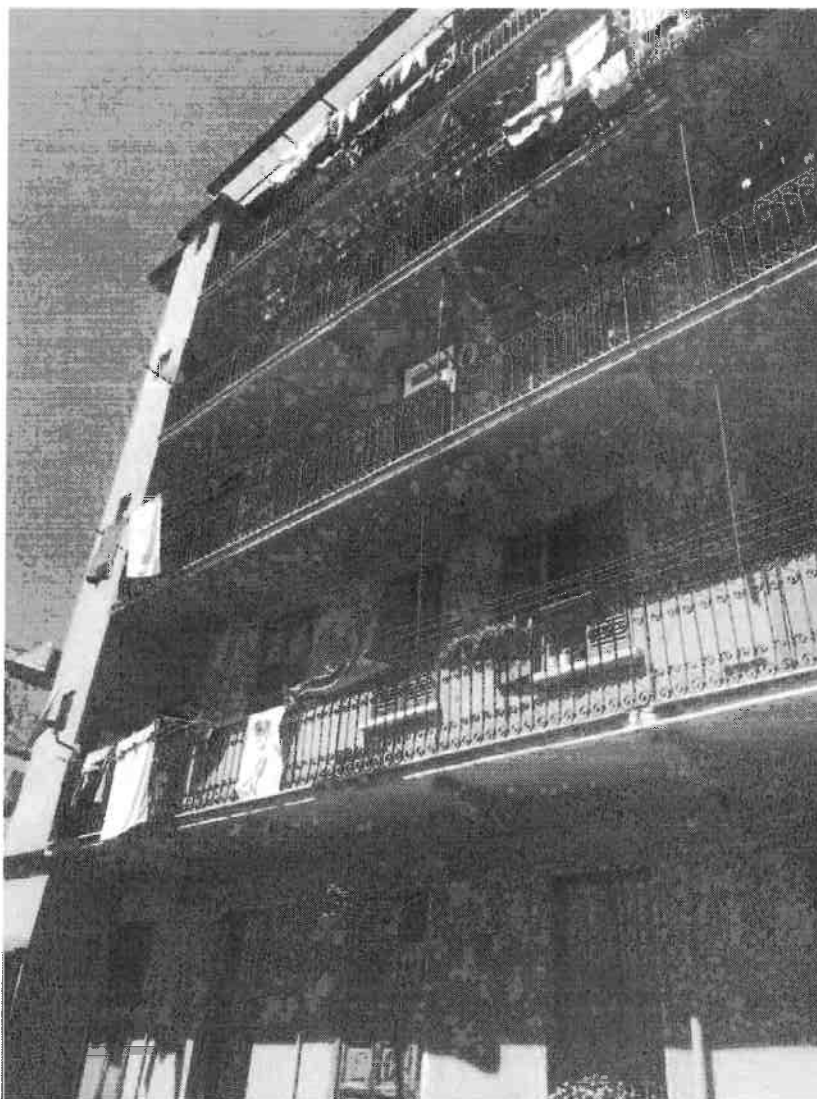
situazione prospetto lato cortile interno durante il sopralluogo del 18.05.2021 – foto 1
